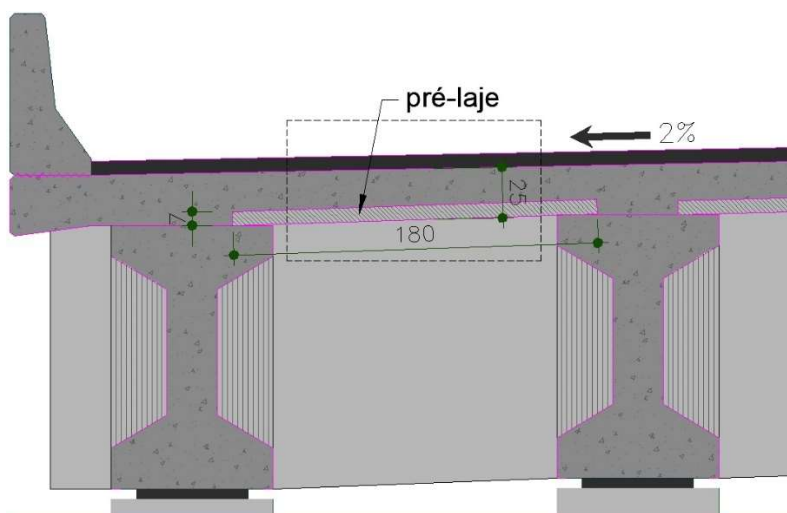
concepção da laje e pré-laje e seu pré-dimensionamento.
